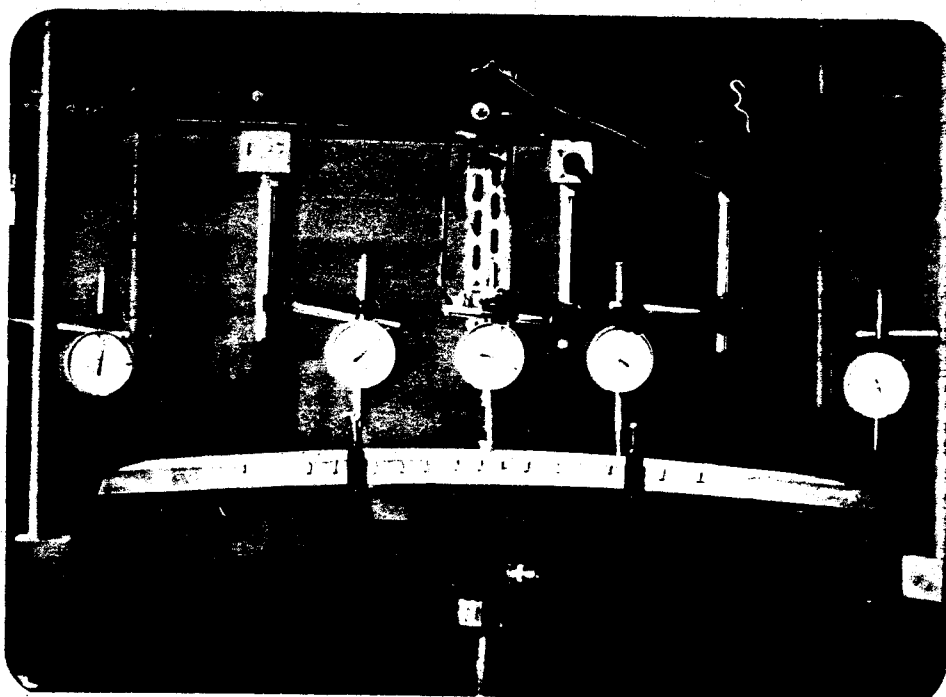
Vista geral de uma viga, sendo ensaiada à flexão.
